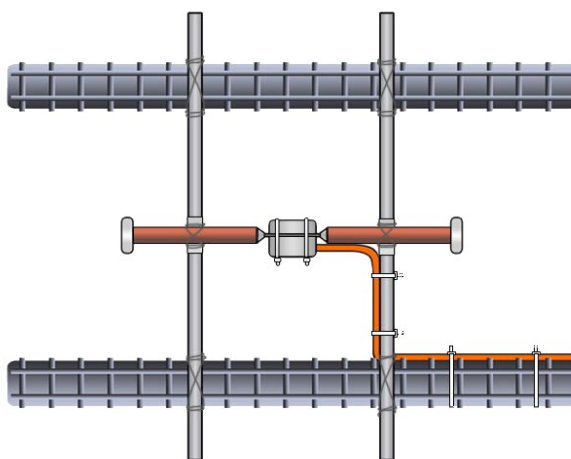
Schema di installazione della strumentazione di monitoraggio.
